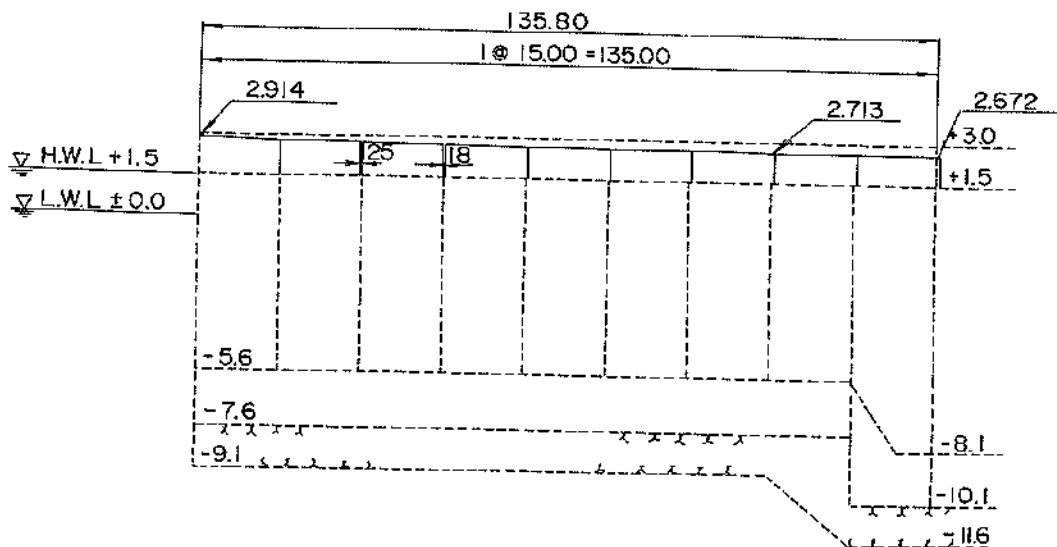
被災状況平面図・法線変位図 (第2埠頭地区, ②東側岸壁(-7.5m))
